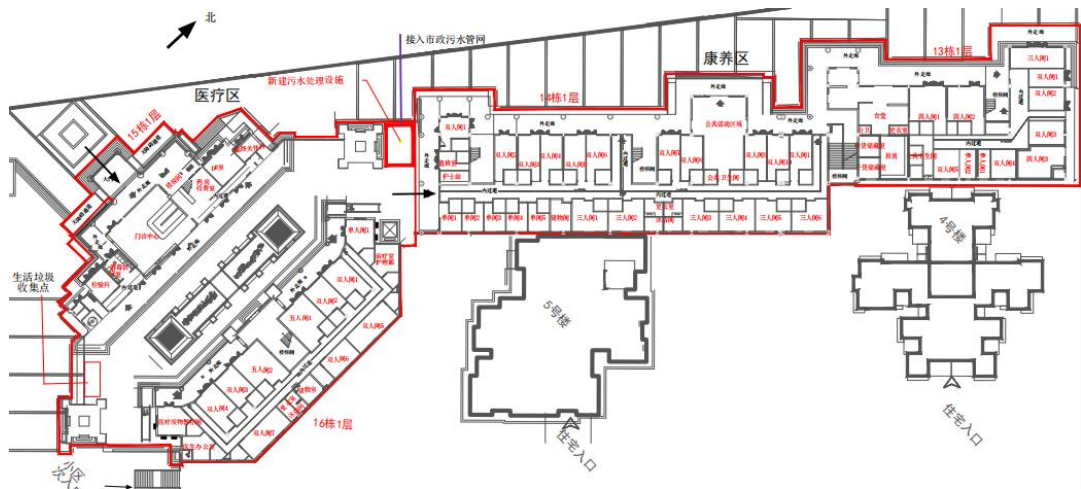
项目总平面布置图-1层（环评推荐方案）
